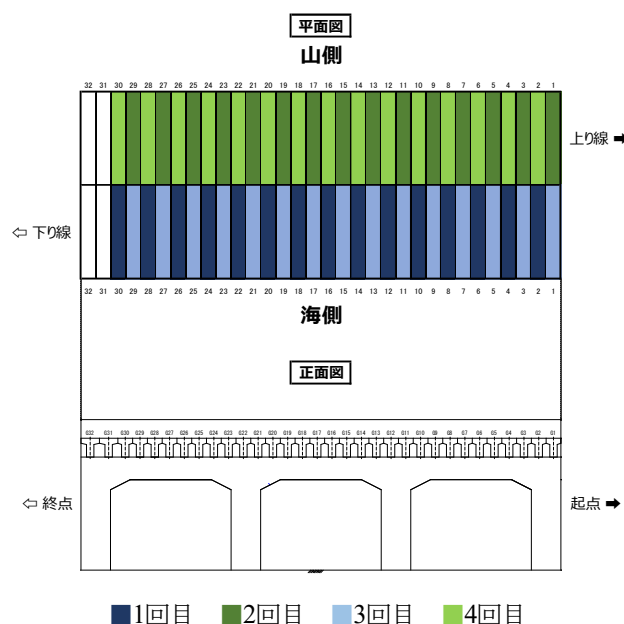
元名ロックシェッドにおけるコンクリート撤去の分割施工
